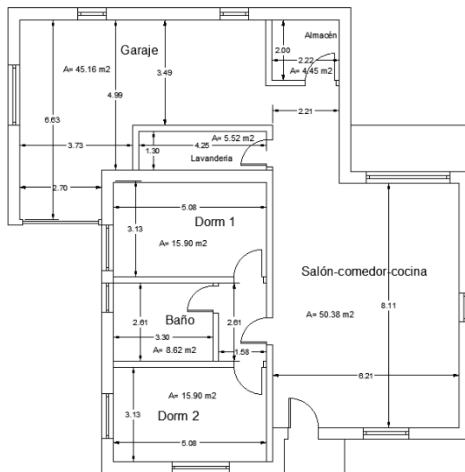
Plano con cotas y áreas por recintos. Fuente propia
